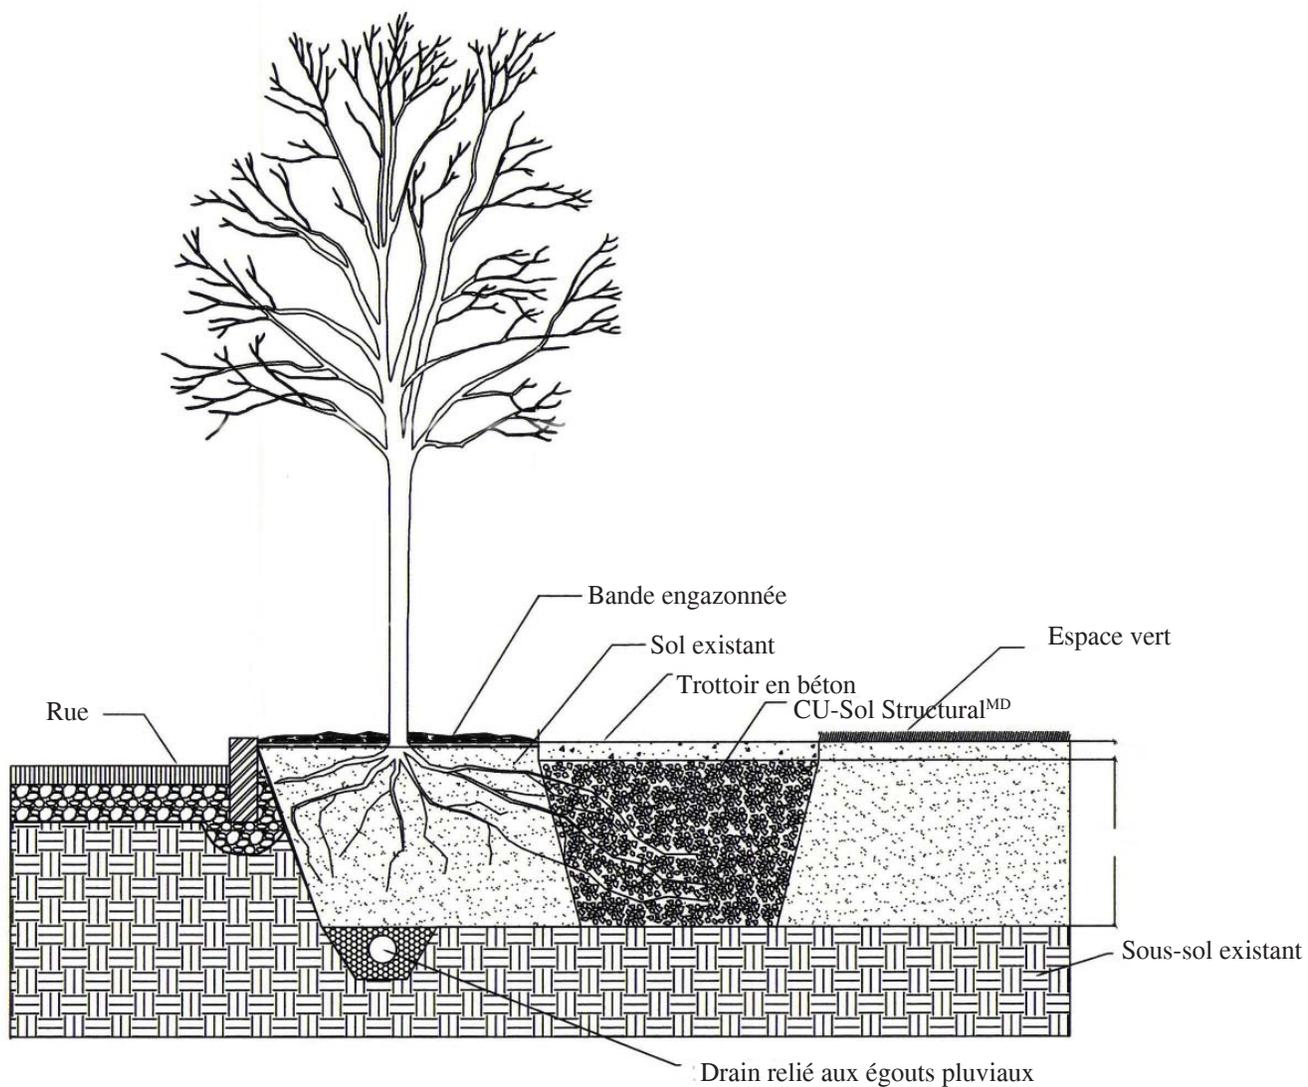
Zone d'expansion racinaire en CU-Sol Structural^{MD} depuis une plantation d'arbre étroite vers un vaste espace vert.
